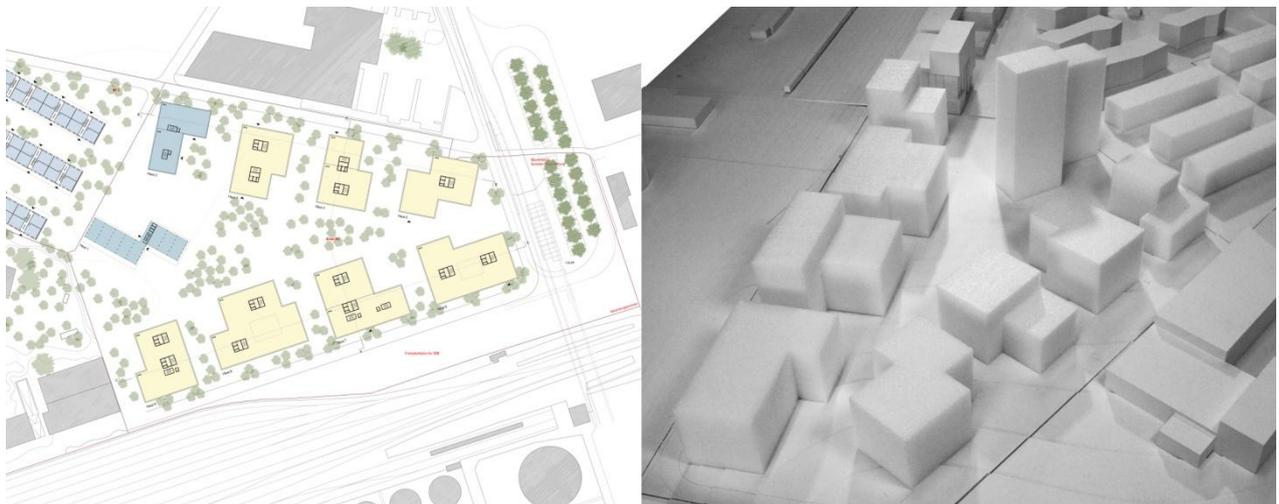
Städtebauliches Konzept, Variante mit Hochhaus im Innenbereich
